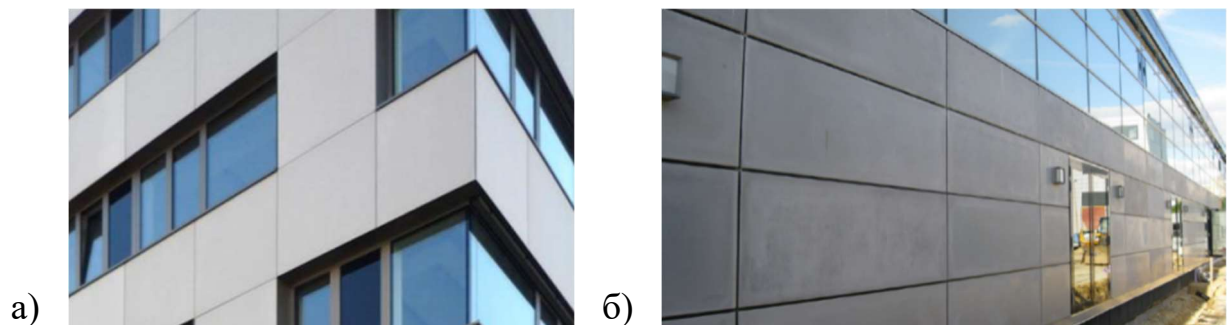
Применение текстиль-бетона для отделки фасада здания:
